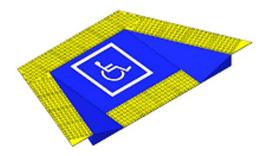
Rampa de acessibilidade em concreto moldado in loco.
